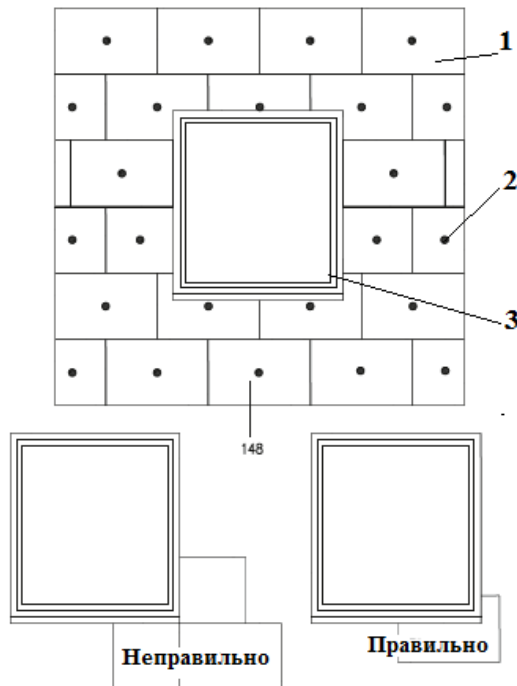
Монтаж плит на фасаде и размещение дюбелей: 1 — минеральная изоляционная плита; 2 — дюбель; 3 — проём на фасаде
